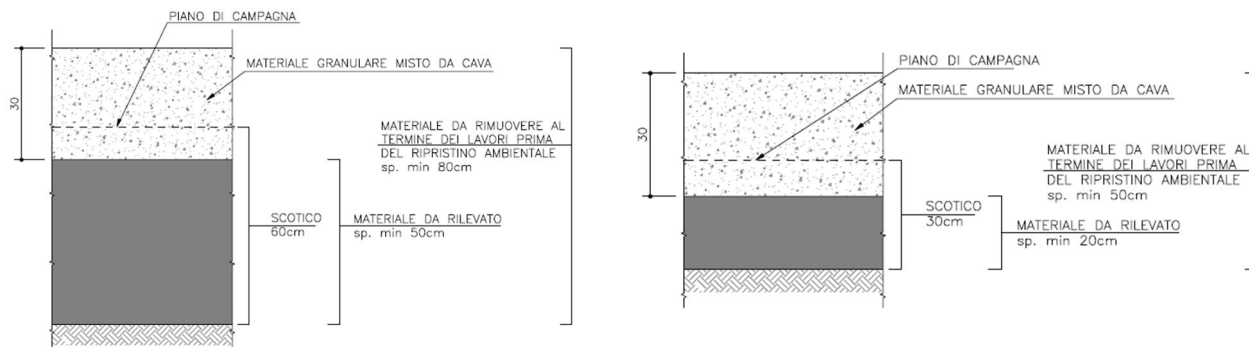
Pacchetti di pavimentazioni previsti nei campi travi
